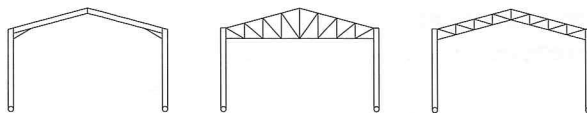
a, b et c: Portiques courants, avec encastremets entre poutres et poteaux
